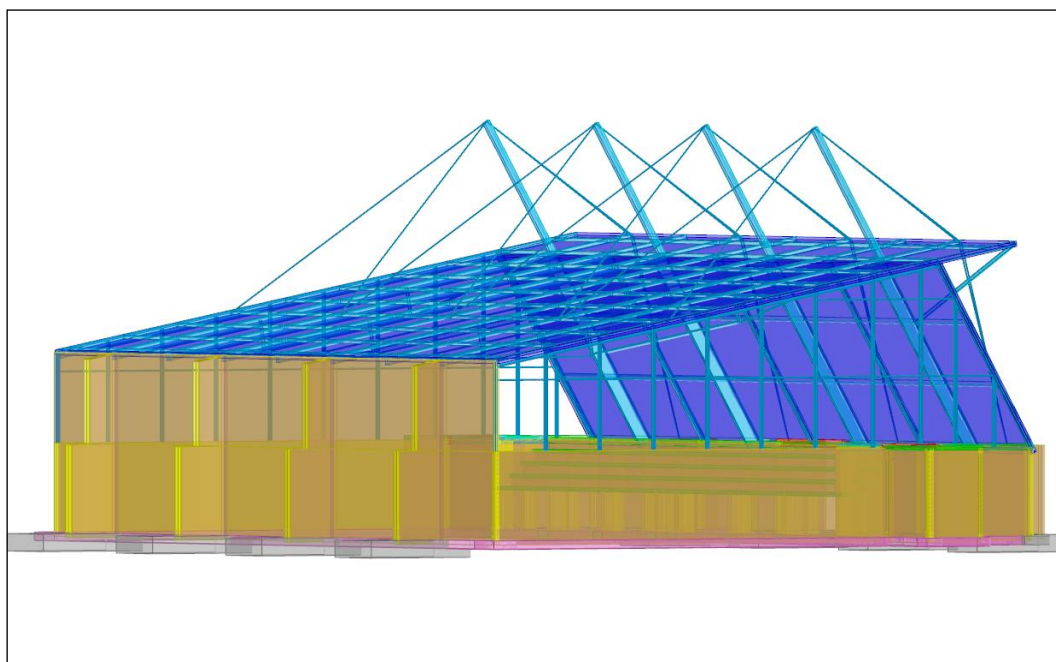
vista del modello FEM (caratteristiche geometriche)
